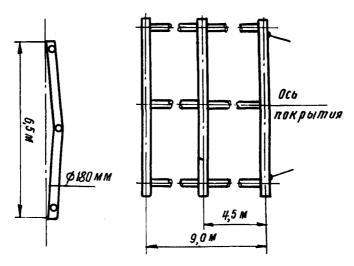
Рама из труб диаметром 150-180мм для планировки выравнивающего слоя или песчаного основания под покрытие шириной 6м
